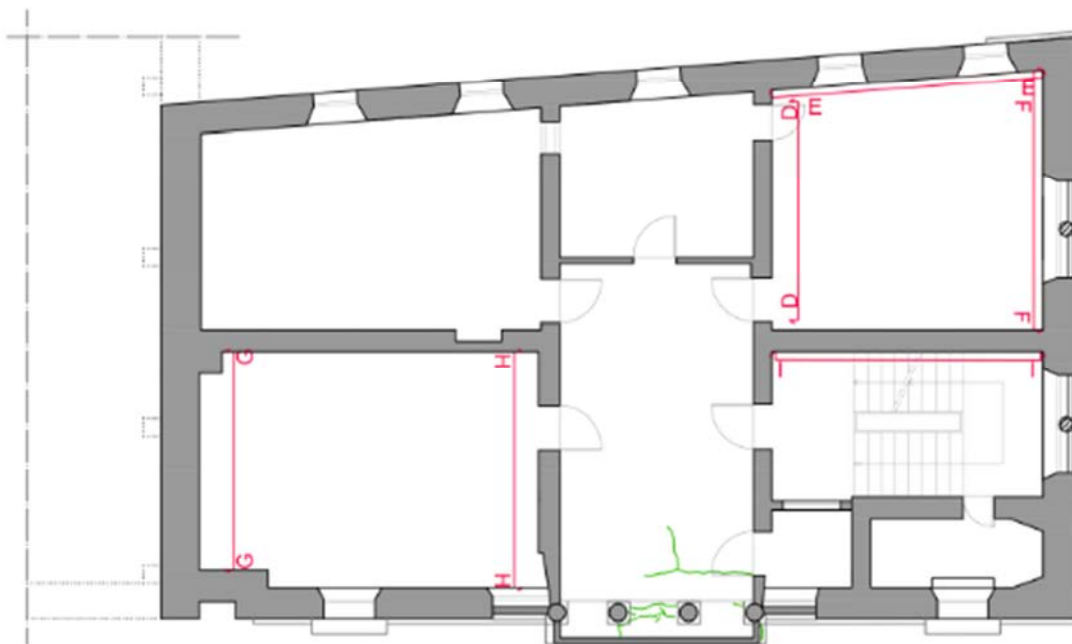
Individuazione in pianta della fessura (in verde) che interessa il pavimento dell'atrio al piano primo.
